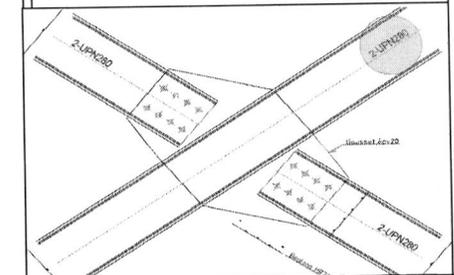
D.A : intersection du contreventement X. ECH 1/20
